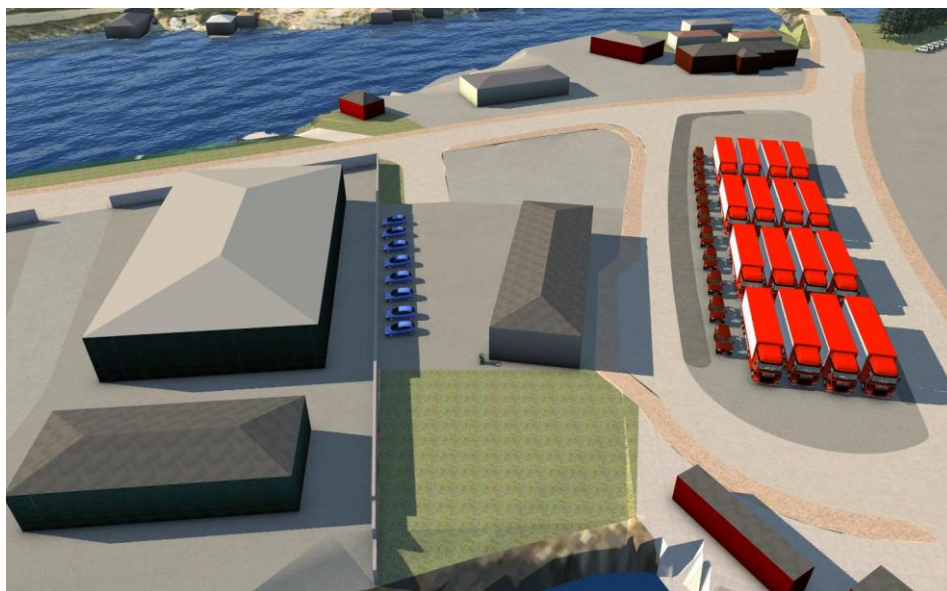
Planlagt oppstillingsplass for ferge. Ref. Rambøll.
